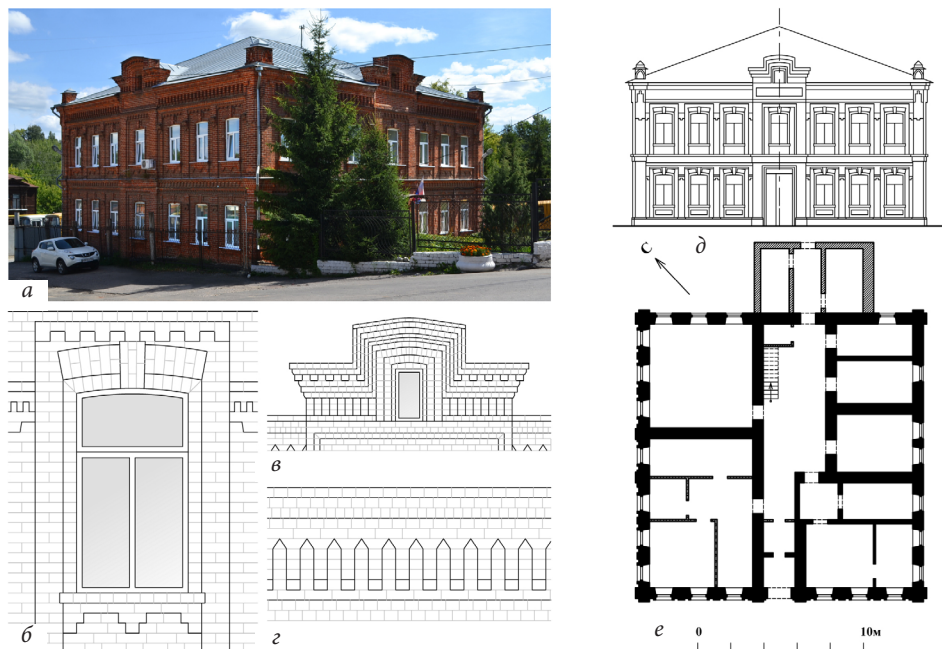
Здание женского двухклассного училища (ул. Ленина, 27), 1894 г.: *а* – общий вид; *б* – окно; *в* – аттик; *г* – карниз; *д* – схема фасада; *е* – план 1-го этажа
